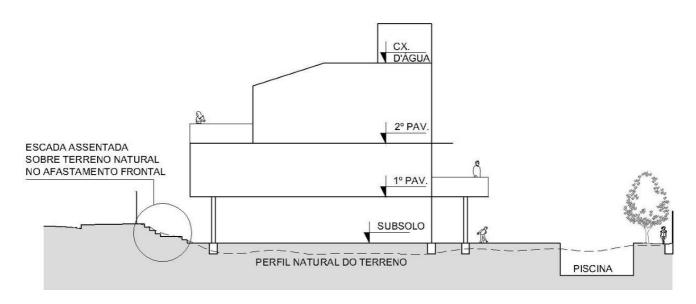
Elemento construtivo no afastamento frontal no terreno em declive: escada
